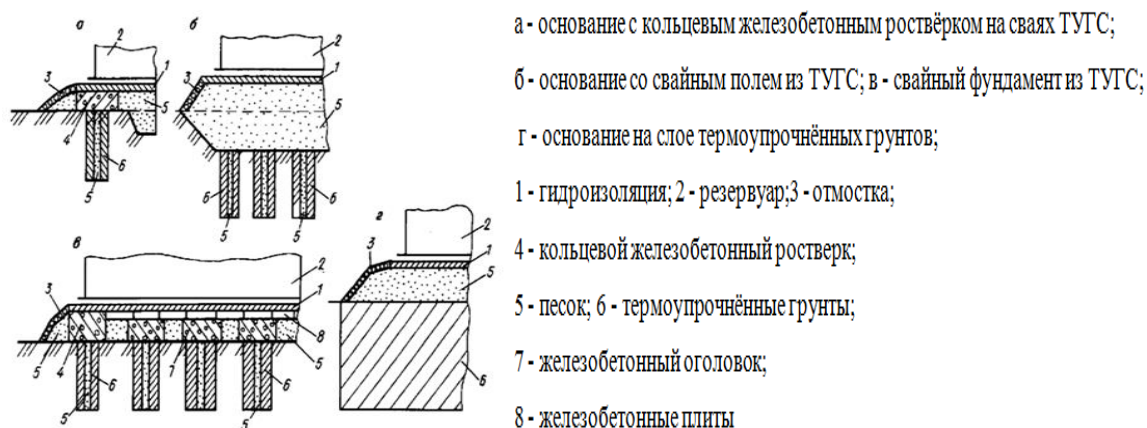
Конструкции оснований и фундаментов резервуаров с применением термоупрочнённых грунтов
